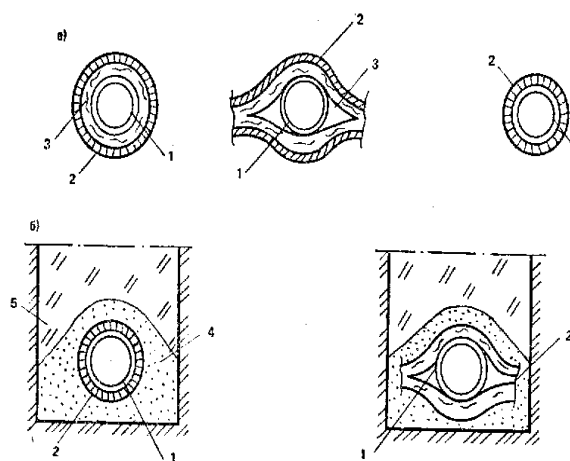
Конструкции трубчатого горизонтального дренажа с фильтрующими обертками из волокнистых материалов:
